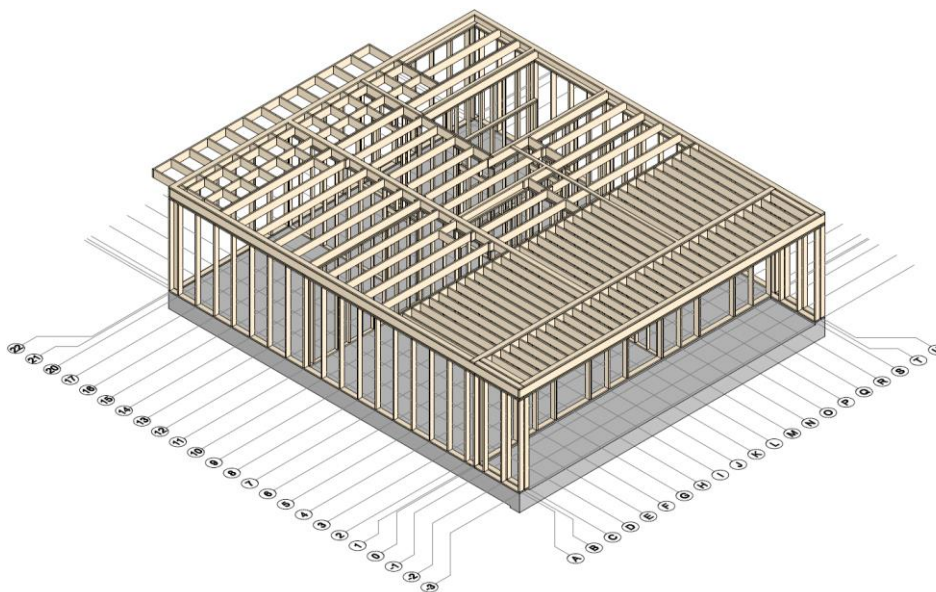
Axonometria estrutural com paredes do piso térreo e pavimento do piso 1.
